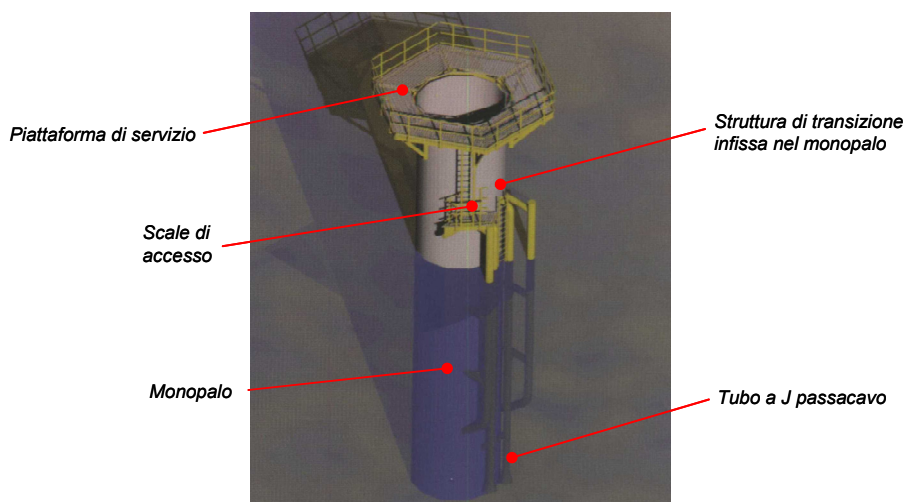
Schema descrittivo della fondazione e della struttura di transizione.
